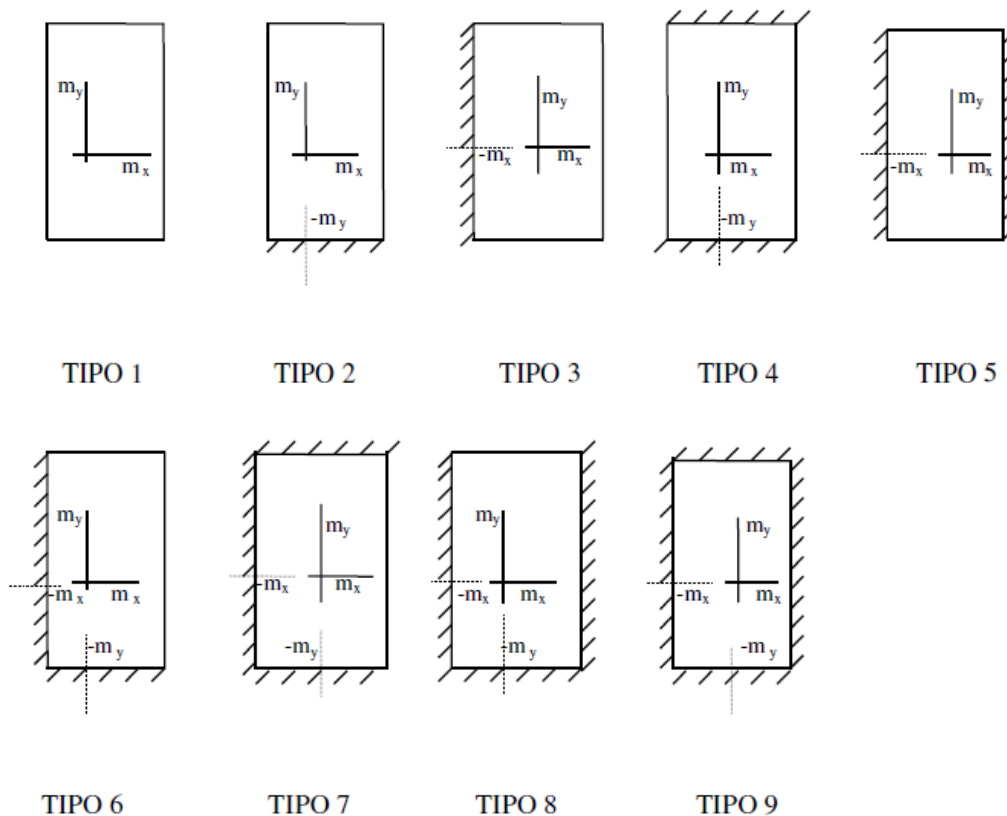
Tipos de lajes em função de sua condição de apoio[3]
